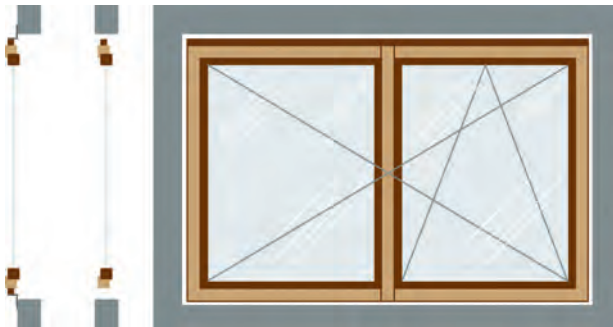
Fenster in einer Fassadenöffnung bzw. vor der Fassade
